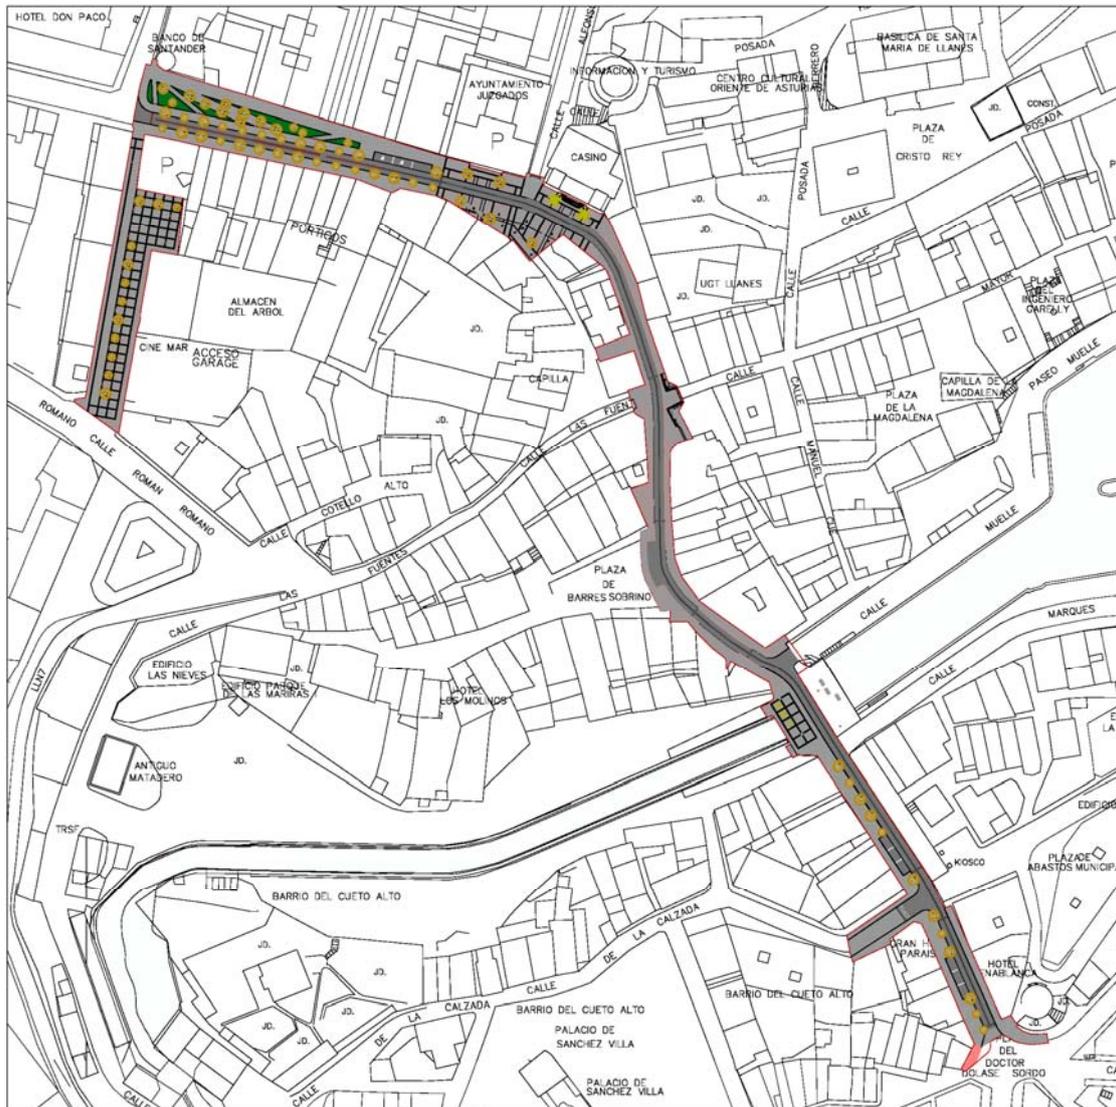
Plano de planta del proyecto de urbanización de las calles de Llanes.
